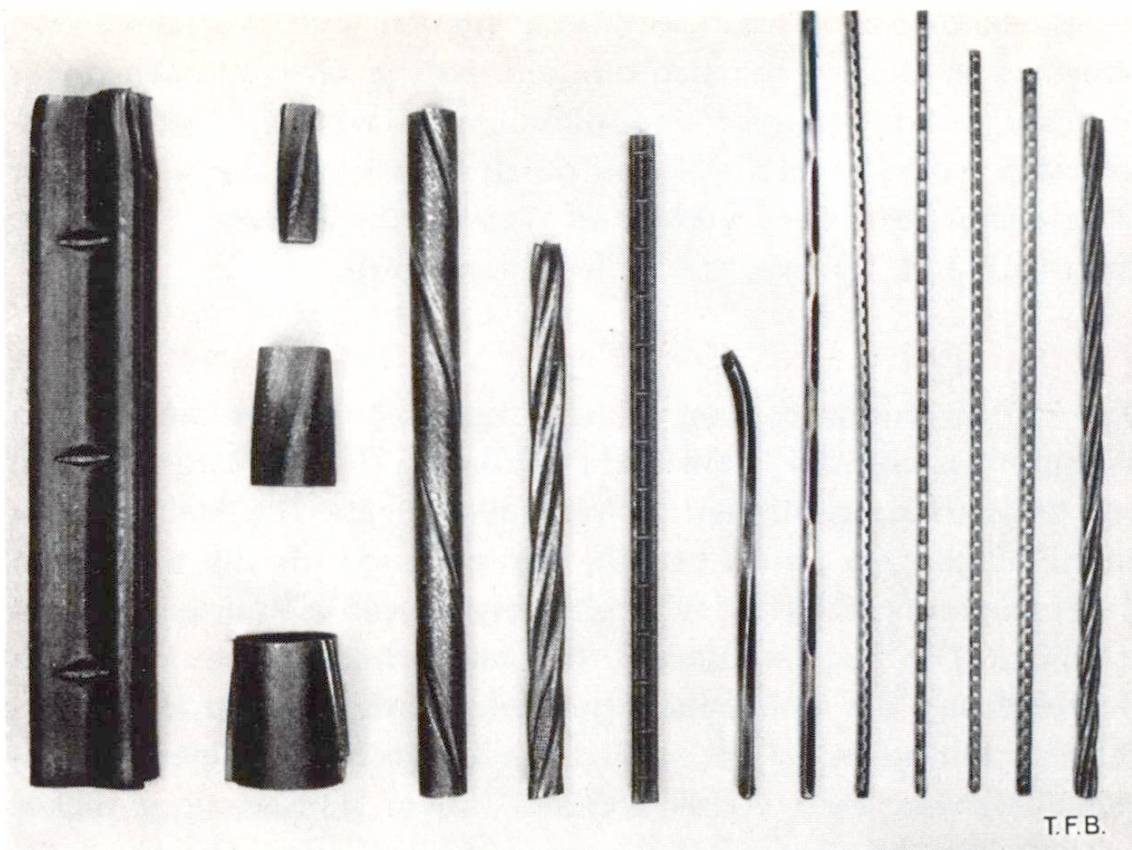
Spezialarmierungen für Eisenbeton (links) und vorgespannten Beton (rechts)
